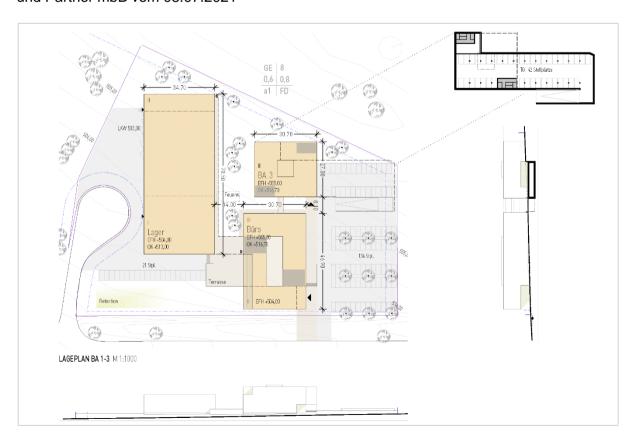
Ewimed GmbH – Neubau Nasswasen, städtebaulicher Vorentwurf / Lageplan, Ansicht vom 08.07.2021, Sprenger Architekten (Ausschnitt o. M.)
